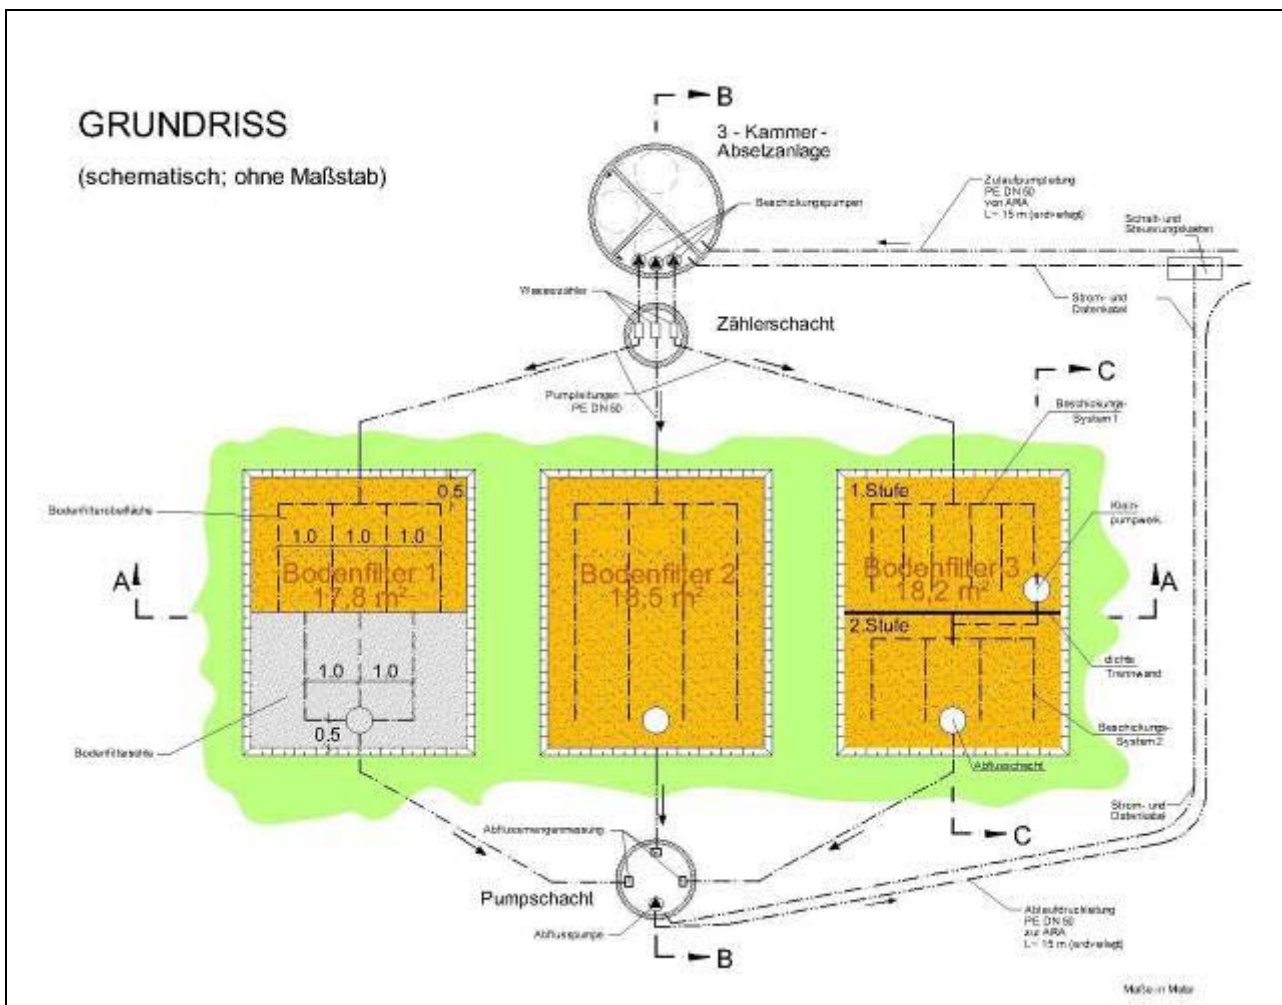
Lageplan der Forschungsanlage „Bepflanzte Bodenfilter“ in Ernsthofen
